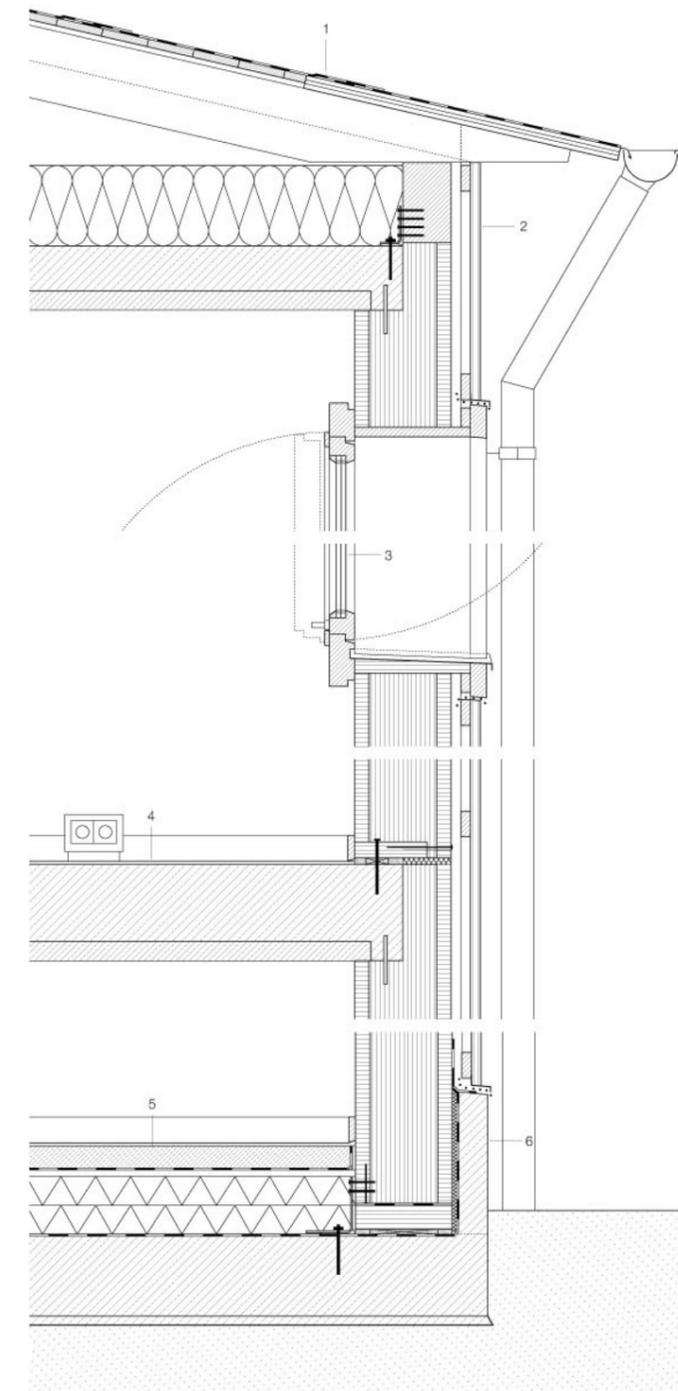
Fassadenschnitt Gebäude Holz massiv:
